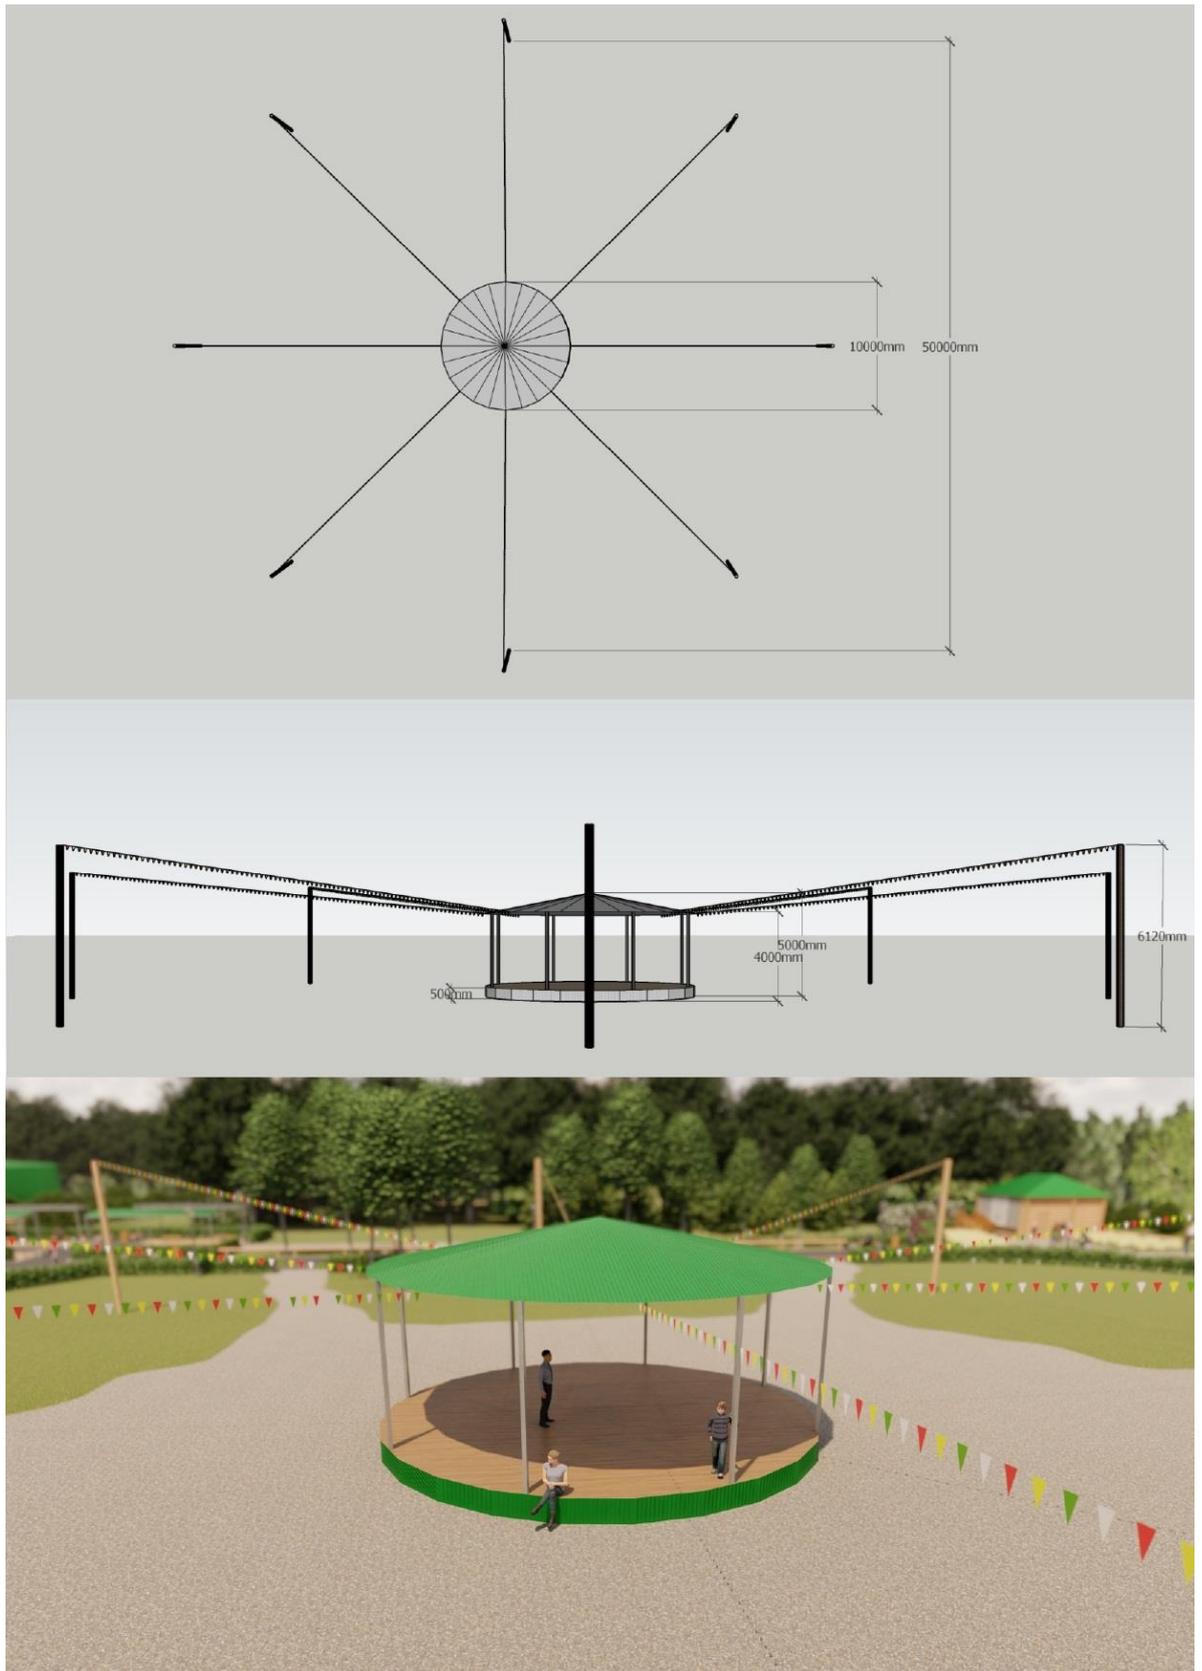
Разбивочный чертеж и визуализация площадки для выступлений
